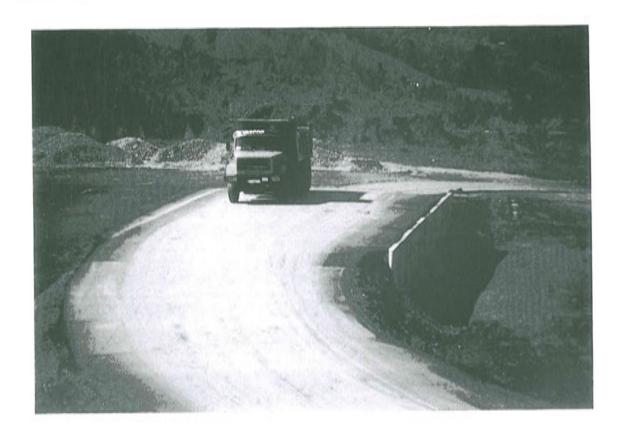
Estructura de tierra reforzada. Generación de tráfico.
